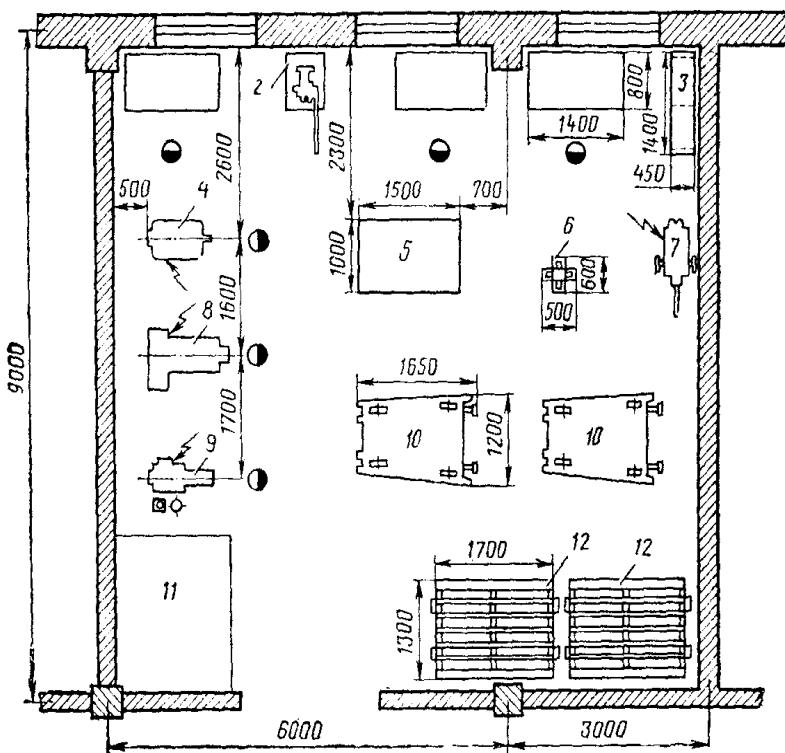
Технологічне планування бляхарського відділення: 1 — верстаки; 2 — ножиці; 3 — стелаж; 4 — станок вертикально-свердильний; 5 — плита рівняльна; 6 — стенд для ручного рихтування; 7 — станок шліфувальний; 8 — зиг-машина; 9 — установка для зварювання; 10 — візок-стенд для ремонту кабін; 11 — місце для зберігання листового матеріалу; 12 — стелажі для крил
